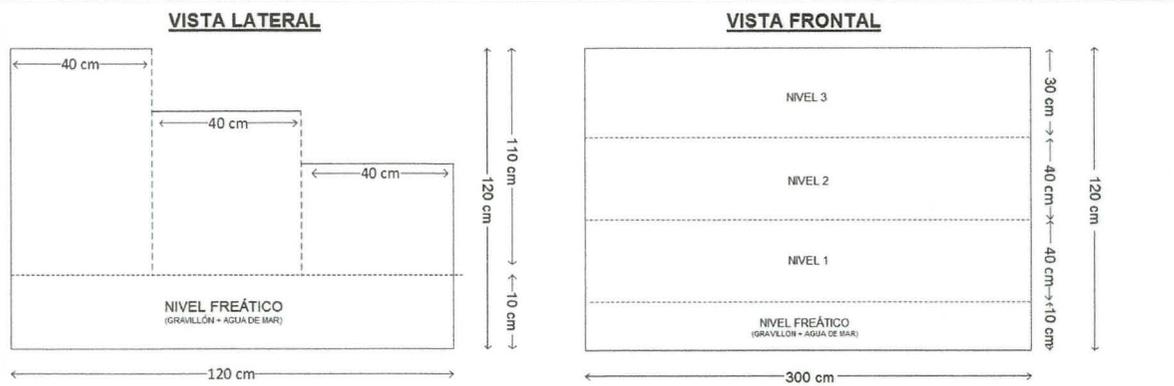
Distintas vistas del plano de las terrazas de cultivo.
